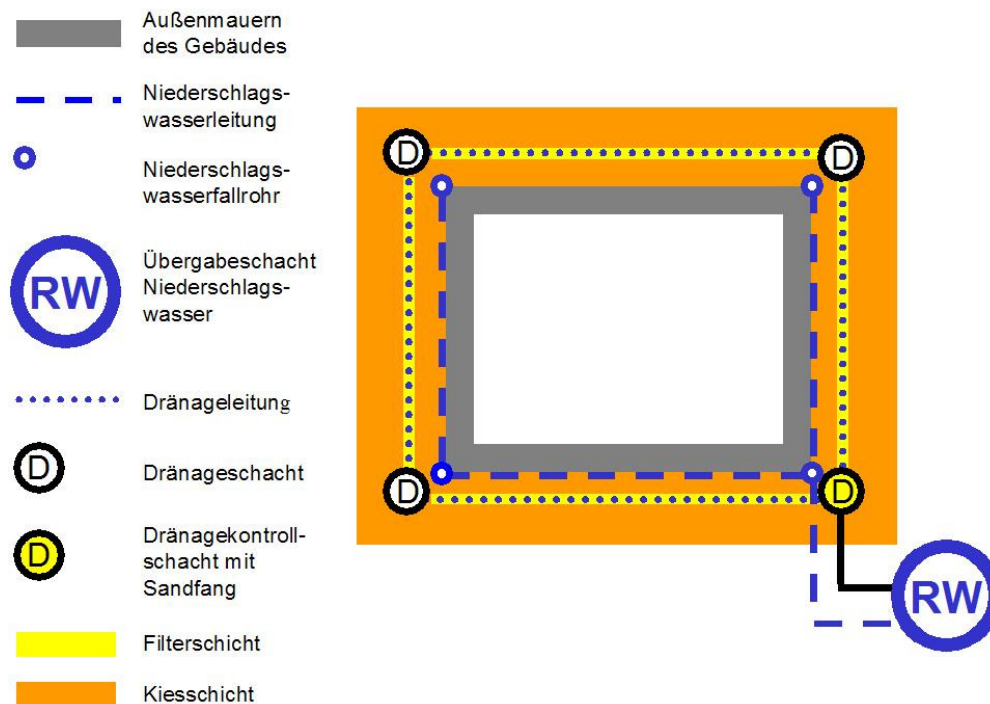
Grundriss einer Niederschlagswasserentwässerung mit Dränage
